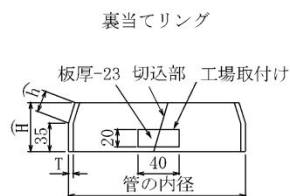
鋼管杭の半自動溶接現場継手標準形状寸法
